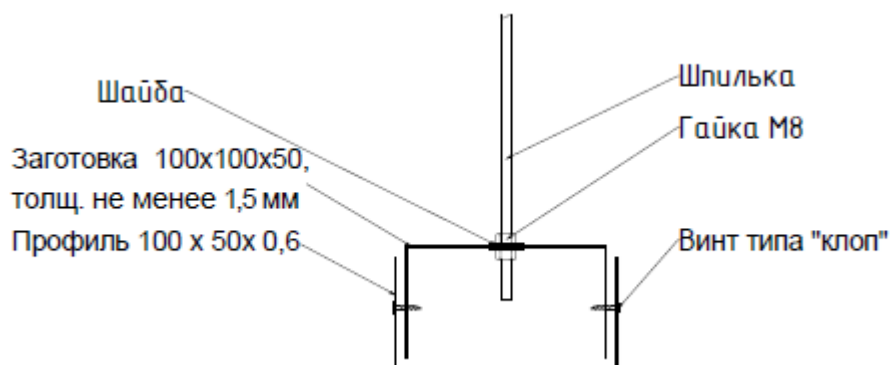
Фиксация заготовки на шпильке гайками, фиксация профиля каркаса к заготовке винтами
